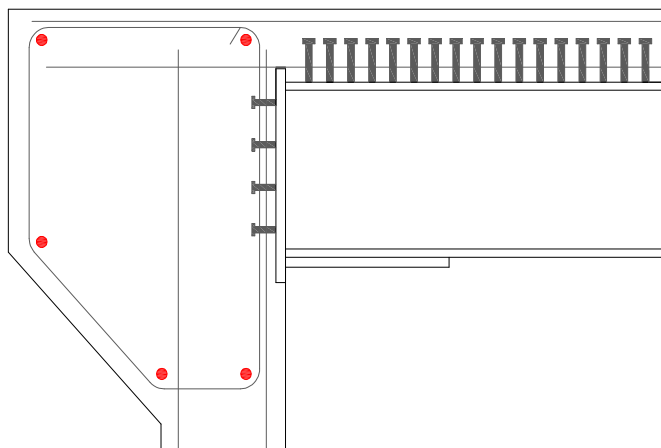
Connessione sovrastruttura in acciaio – spalla, *schema 2
